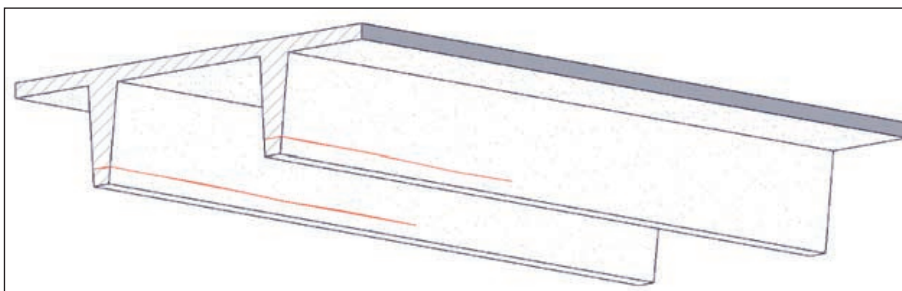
FISURAS EN LOSAS NERVADAS POR CONCENTRACIÓN DE TENSIONES.
